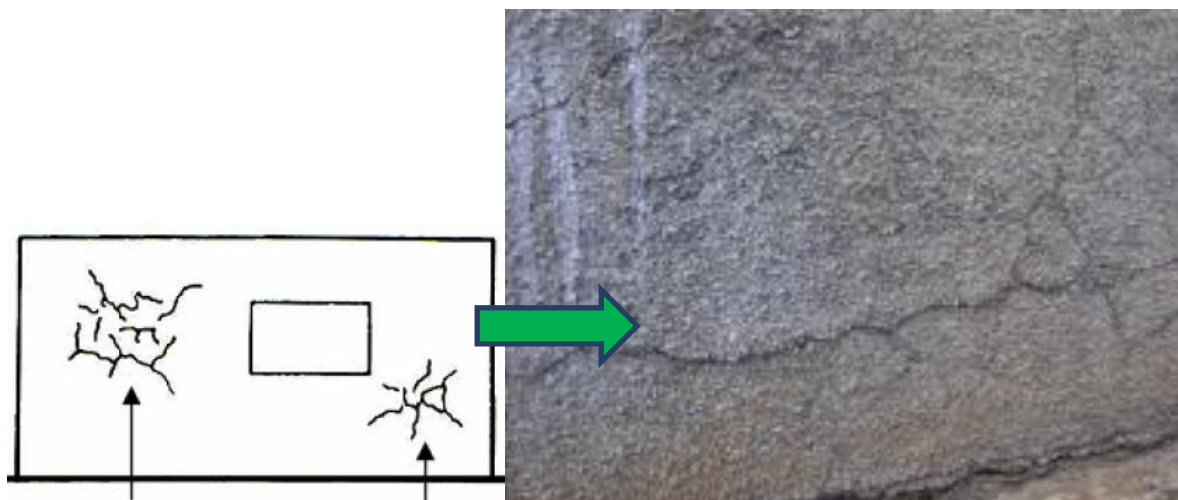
Fissuras causadas pela retração da argamassa de revestimento-Moradia N°6.
